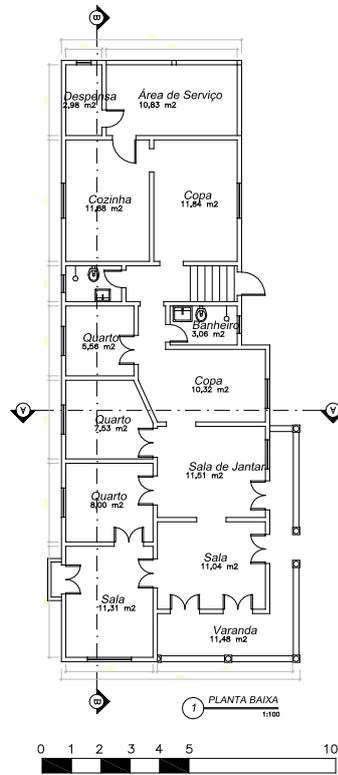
Planta pavimento térreo - Casa Martha Rodrigues
